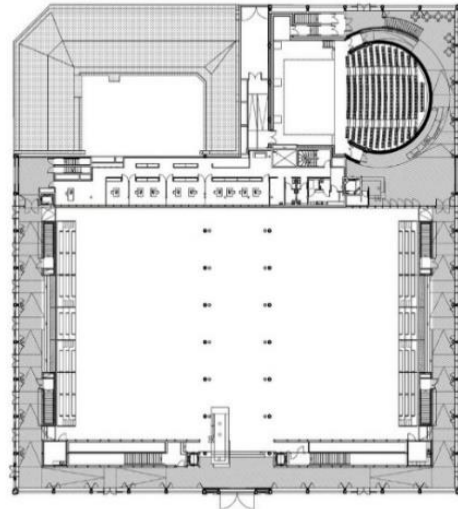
Planta General – Mercado Carreau du Temple (Fuente: studioMilo Architecture, 2014)
